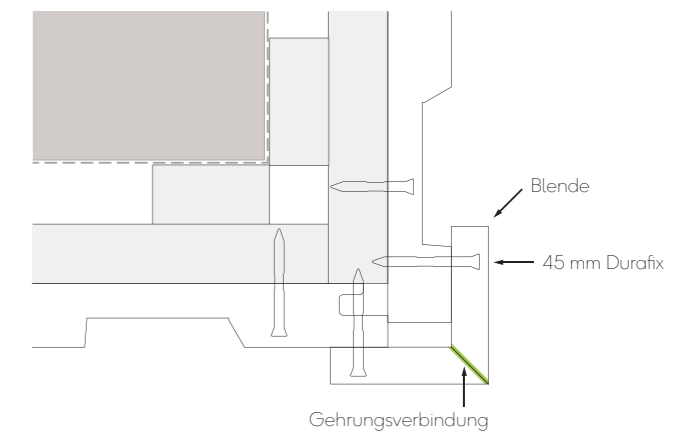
Details der auf Gehrung geschnittenen Außenecke
